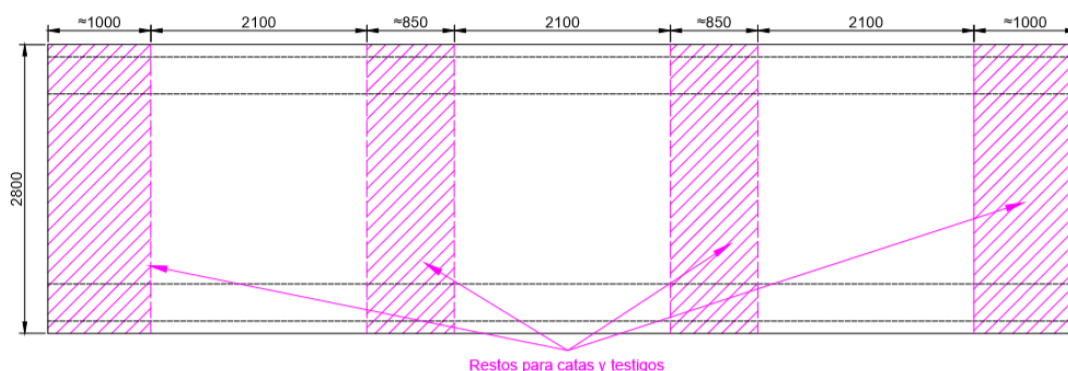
Corte de la sección longitudinal propuesta final con daños en los extremos
